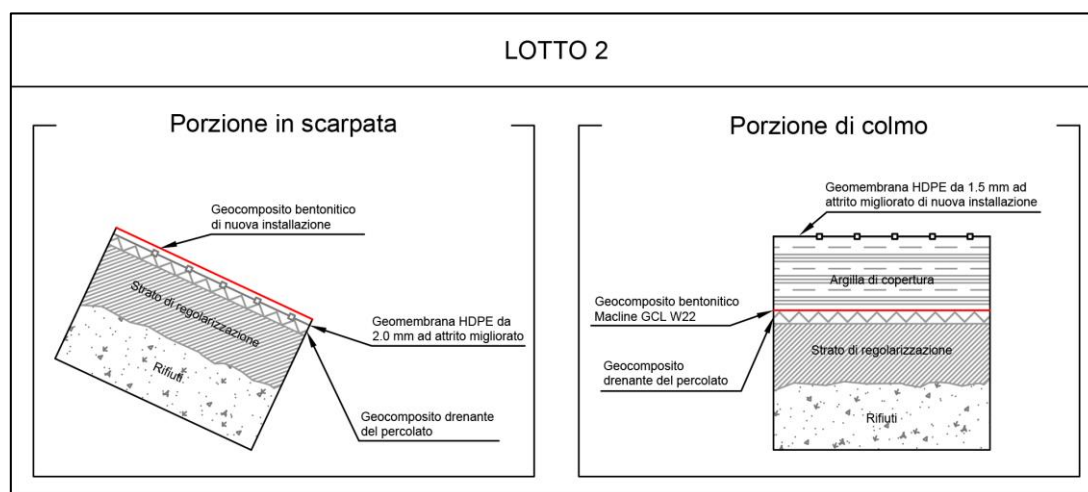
9 – Sezione tipo LOTTO 2, area interna sedime di LOTTO 5
